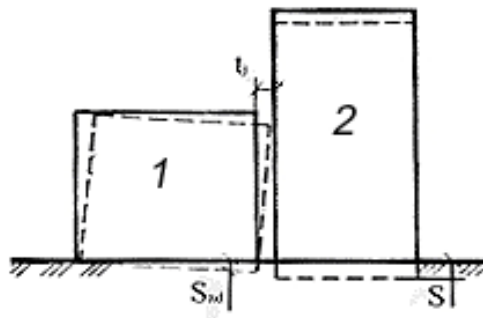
Визначення ширини осадового шва між будівлями: 1 – стара будівля; 2 – нова будівля
